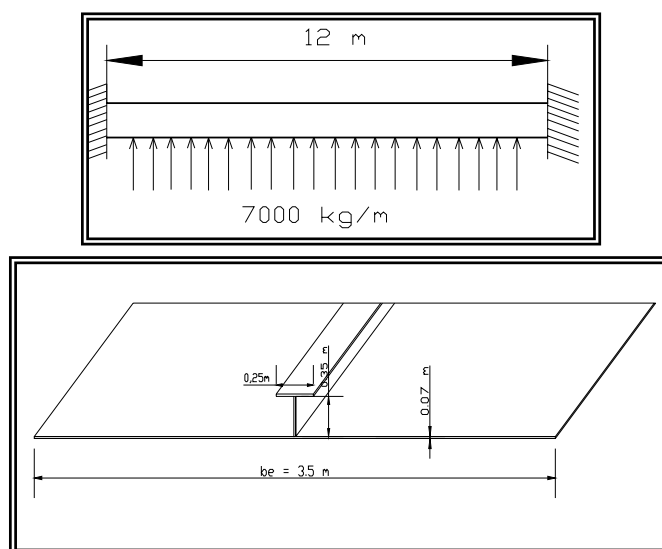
Modelo esquemático del refuerzo con su carga e plancha efectiva
